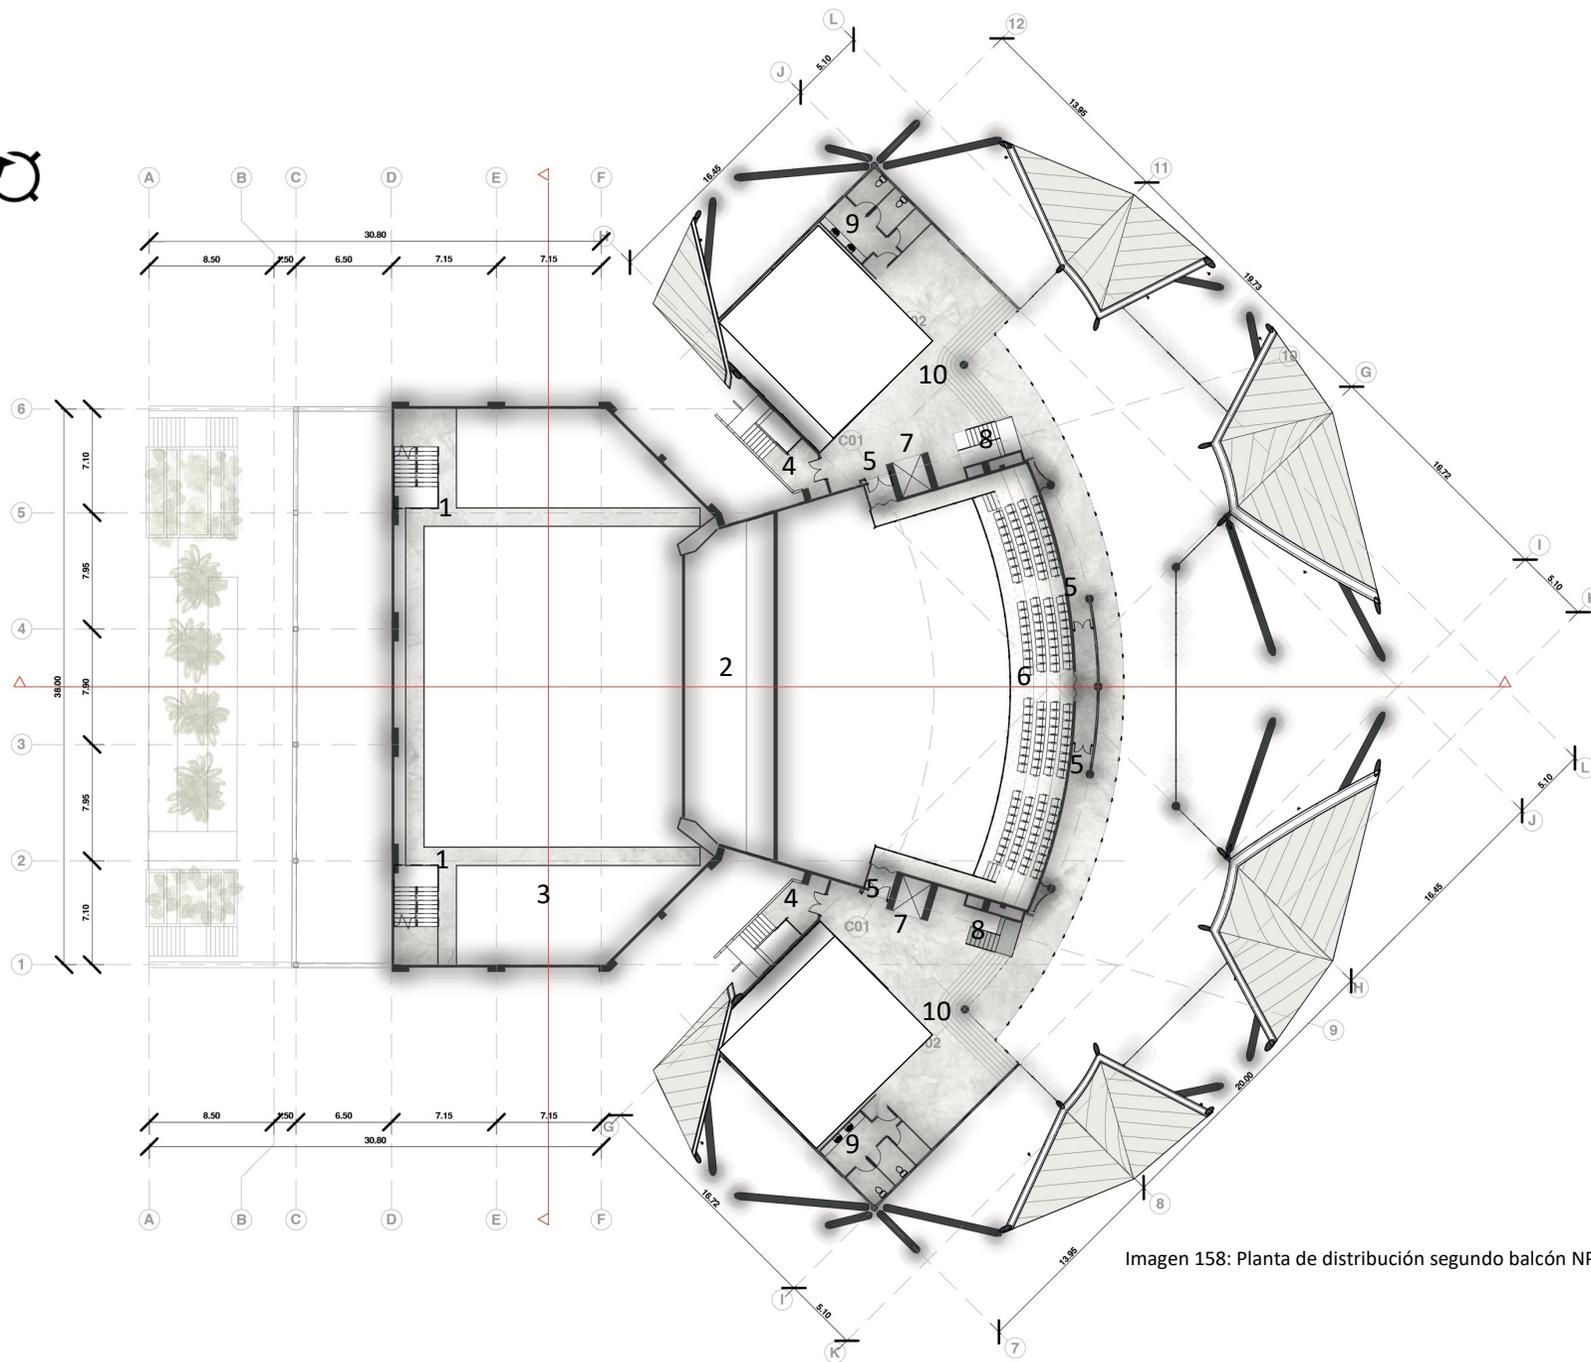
Planta de distribución segundo balcón NPT +10.50 m.
